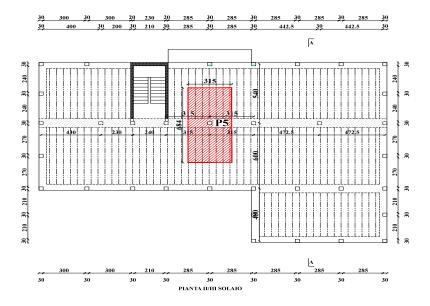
Pianta piano tipo – pilastro P5 (misure in cm)
